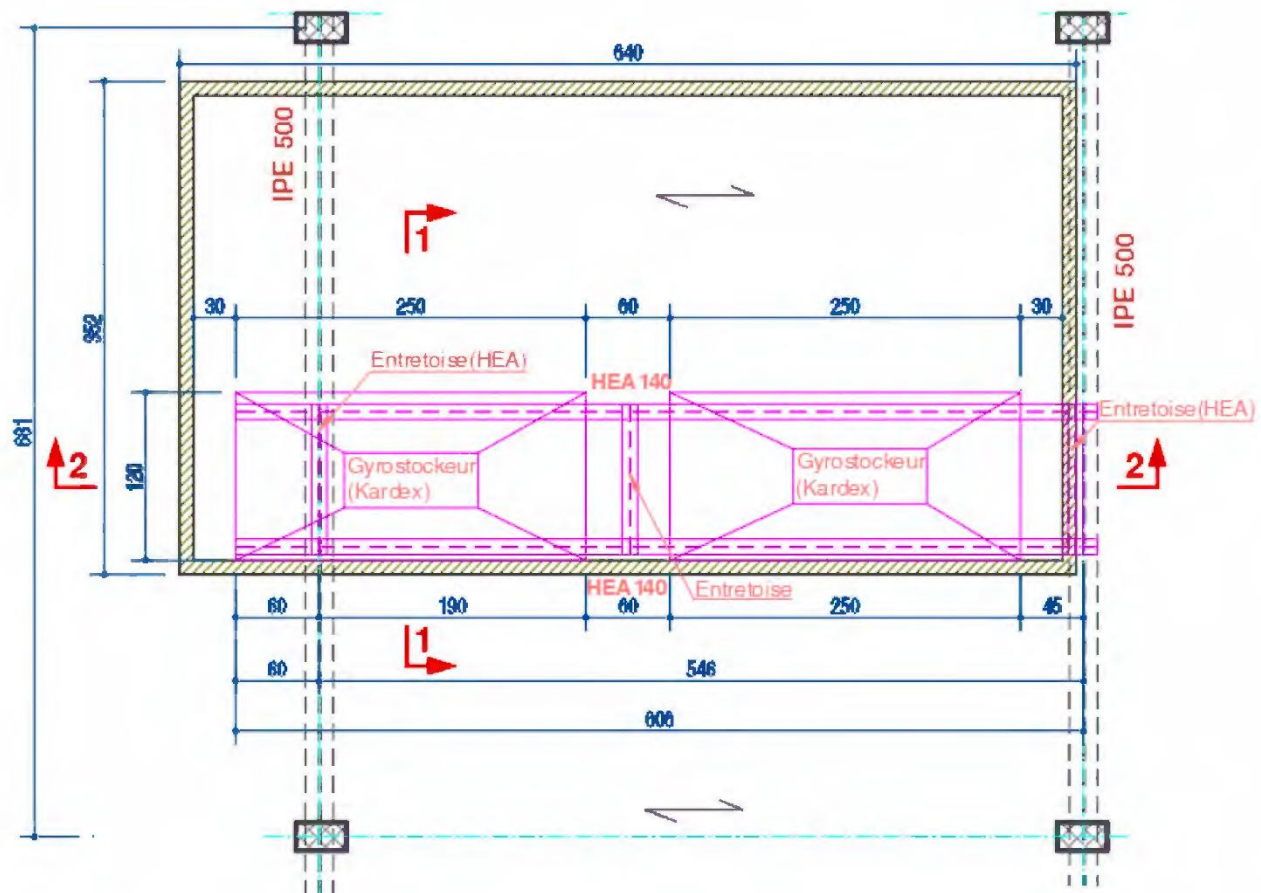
Vue en plan (plancher bas de la chambre froide)
